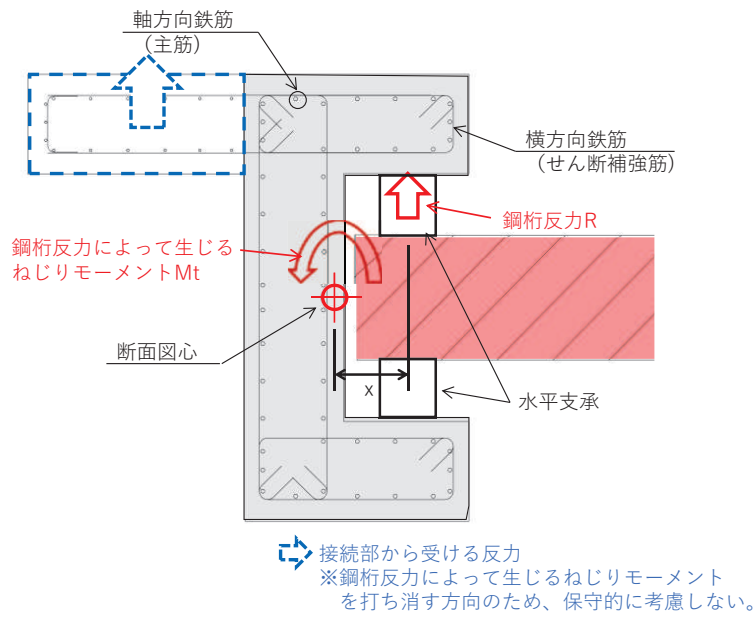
(2) RC 支柱へのねじりモーメント(反力)作用イメージ (平面図)
